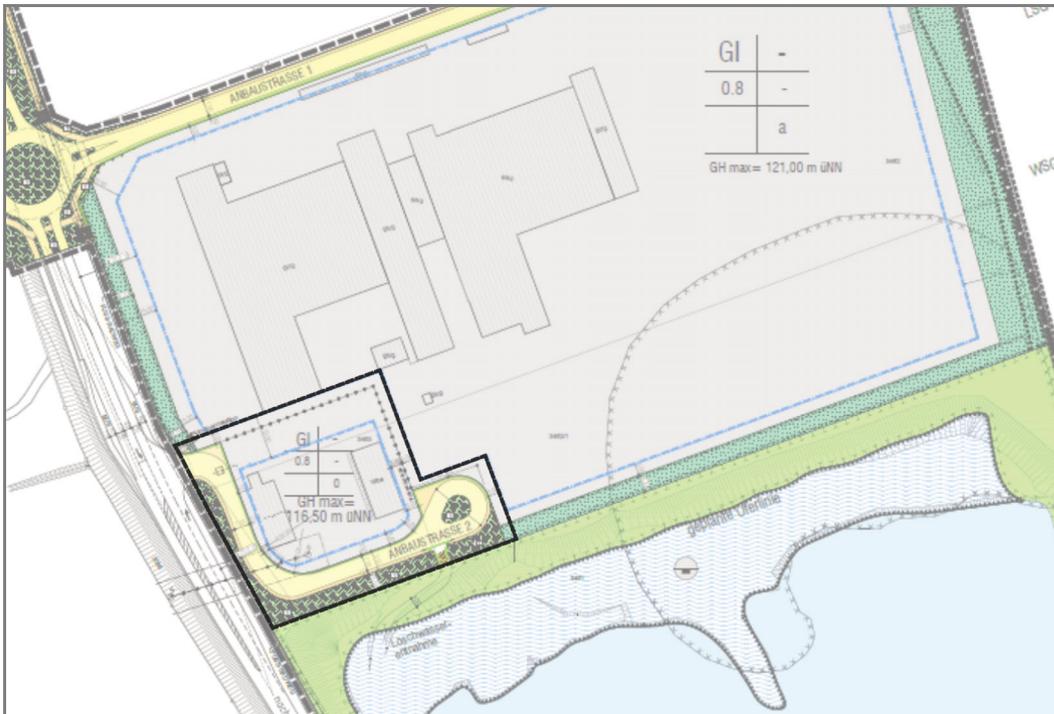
Ausschnitt aus Bebauungsplan "Areal Hebel" mit Geltungsbereich der 1. Änderung
